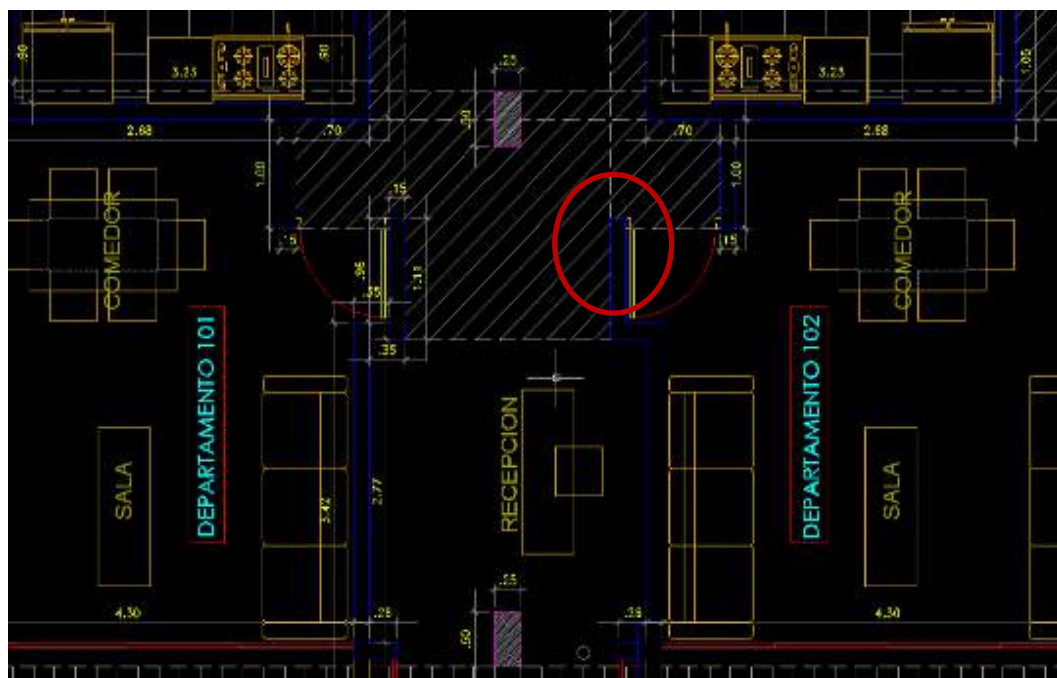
Plano A – 02: La misma columna indica dimensiones de 0.25x0.50 m
